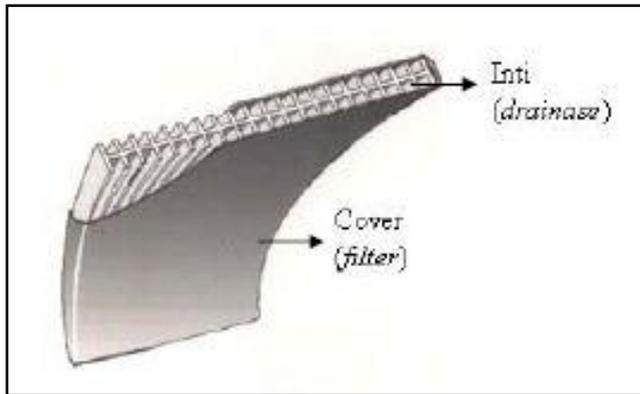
Preloading dengan Prefabricated vertical drains
